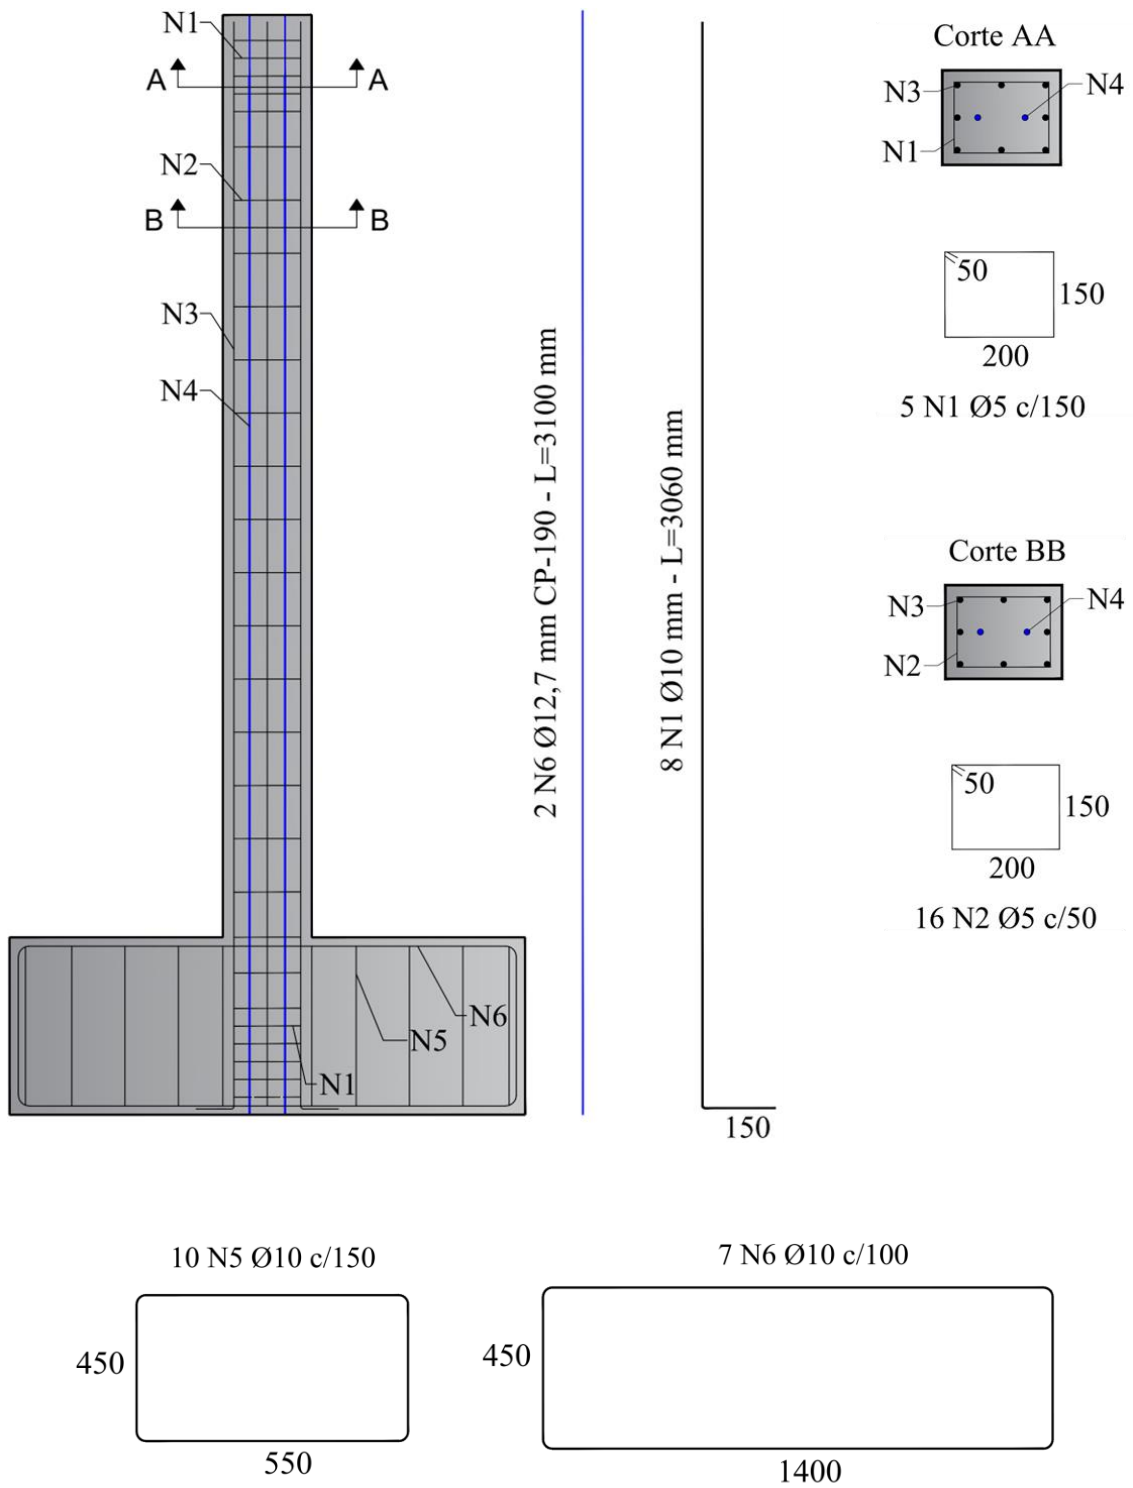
Armaduras dos pilares P3 - dimensões em mm (Fonte: Autor)
